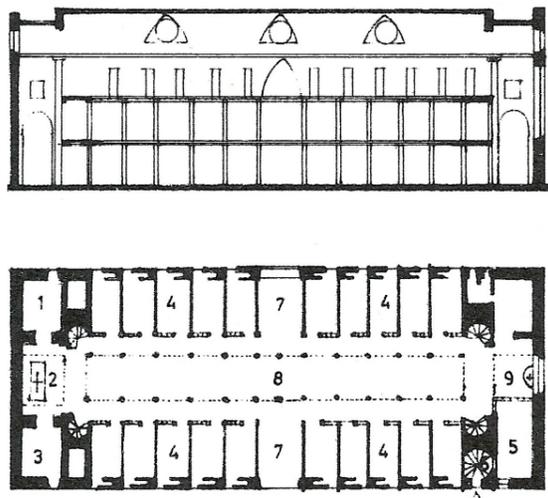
Grundriss | Schnitt Casa di Correzione
